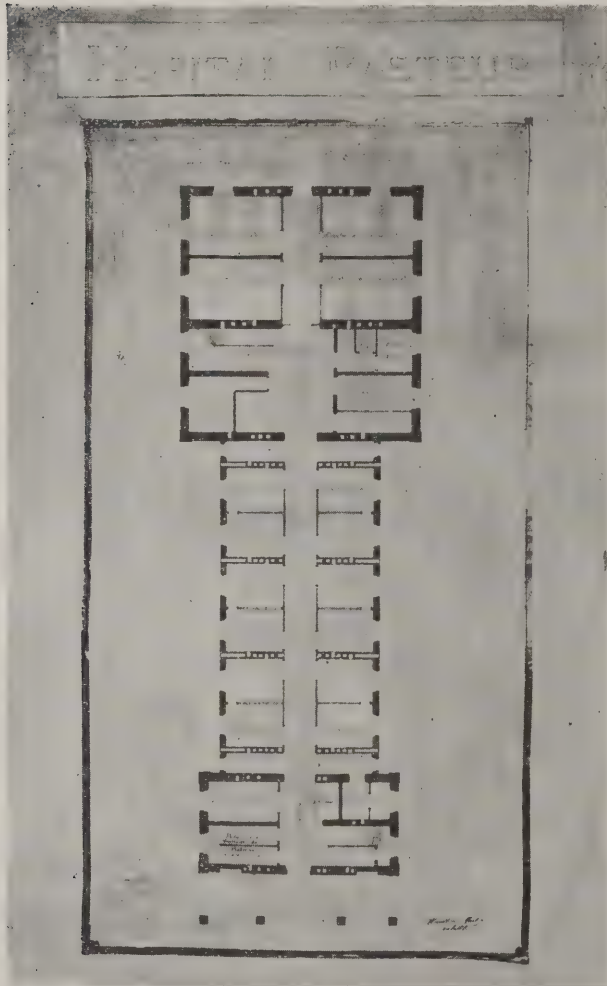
Hôpital Pasteur : plan d'un pavillon, rez-de-chaussée
